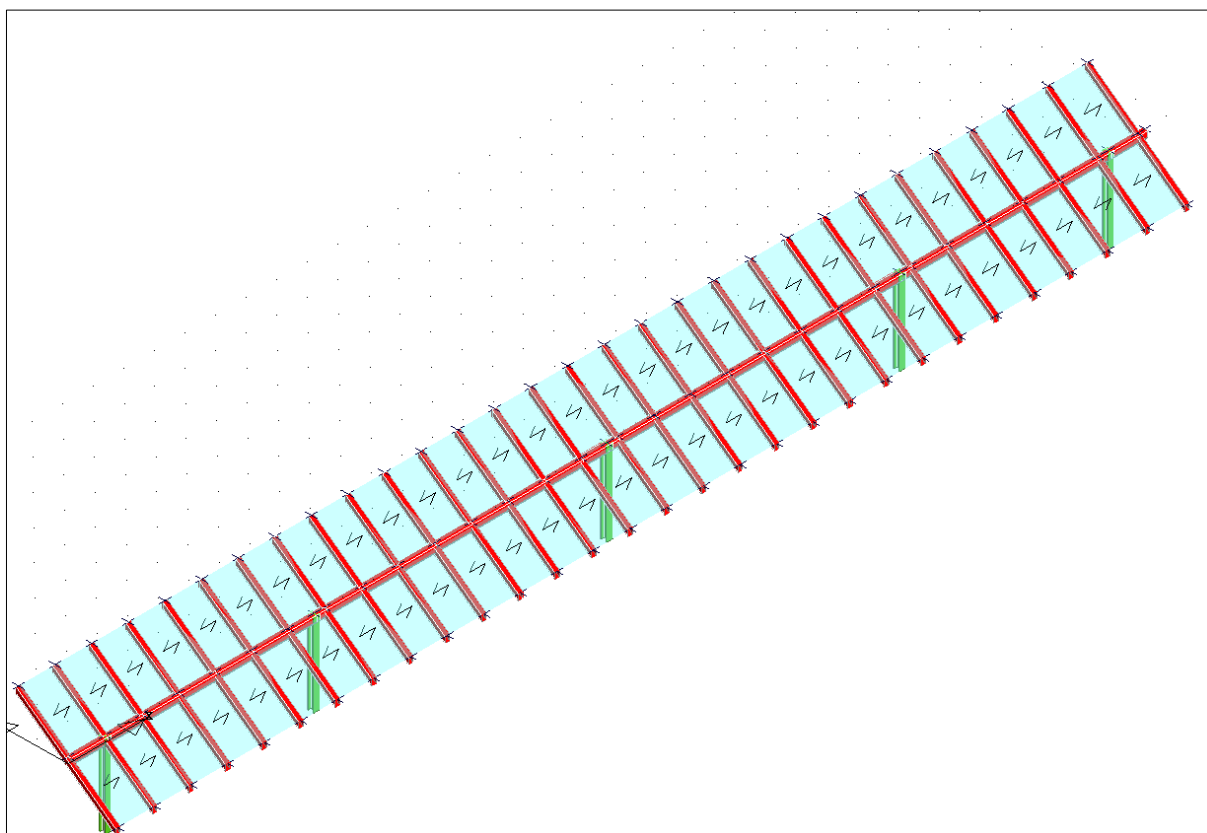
Vista assometrica modello strutturale con posizione della “vela” inclinata di 55°
